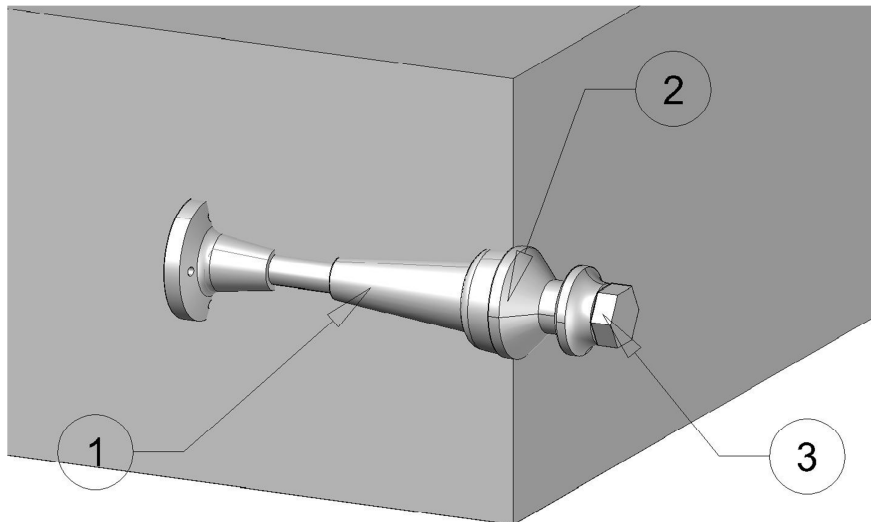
particolare A del sistema di ancoraggio dopo il getto
